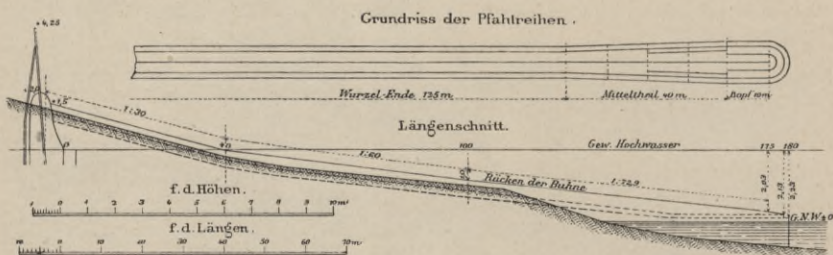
Grundriss und Längenschnitt der Bühnen auf Baltrum.
